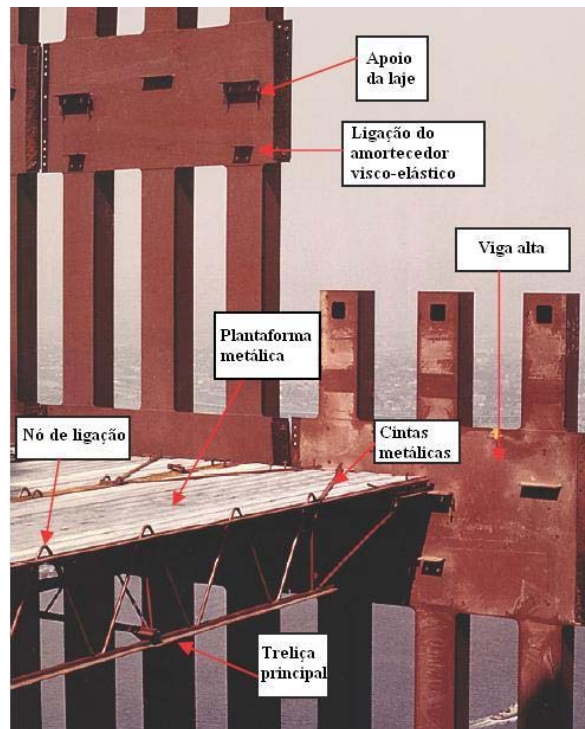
Perspectiva dos pilares da fachada e da treliça metálica de suporte a laje [20].
